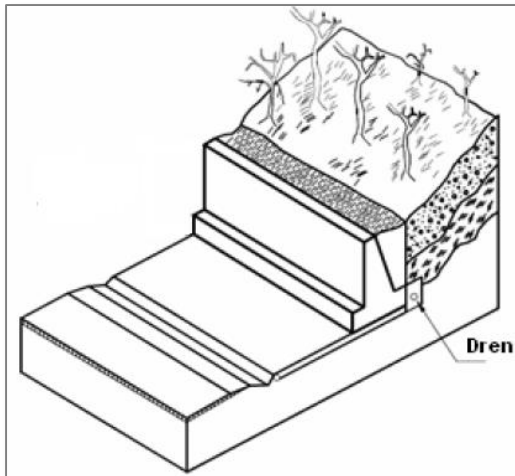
Muro de Gravedad en concreto (Suárez, 1998)
